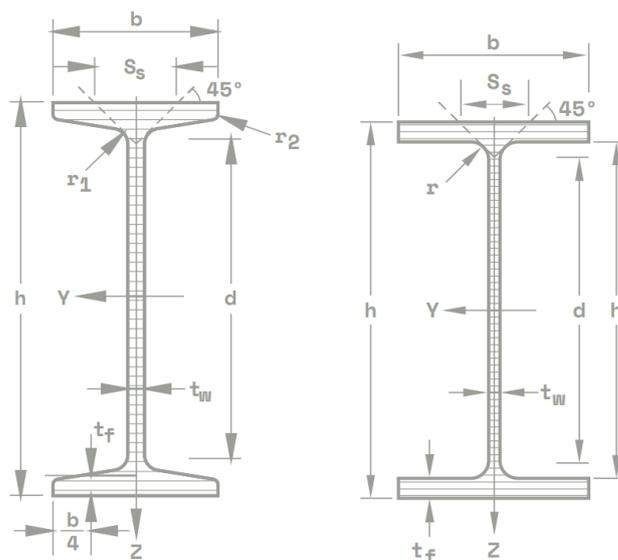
Secção transversal de perfis IPN e HEB, respetivamente [22]
